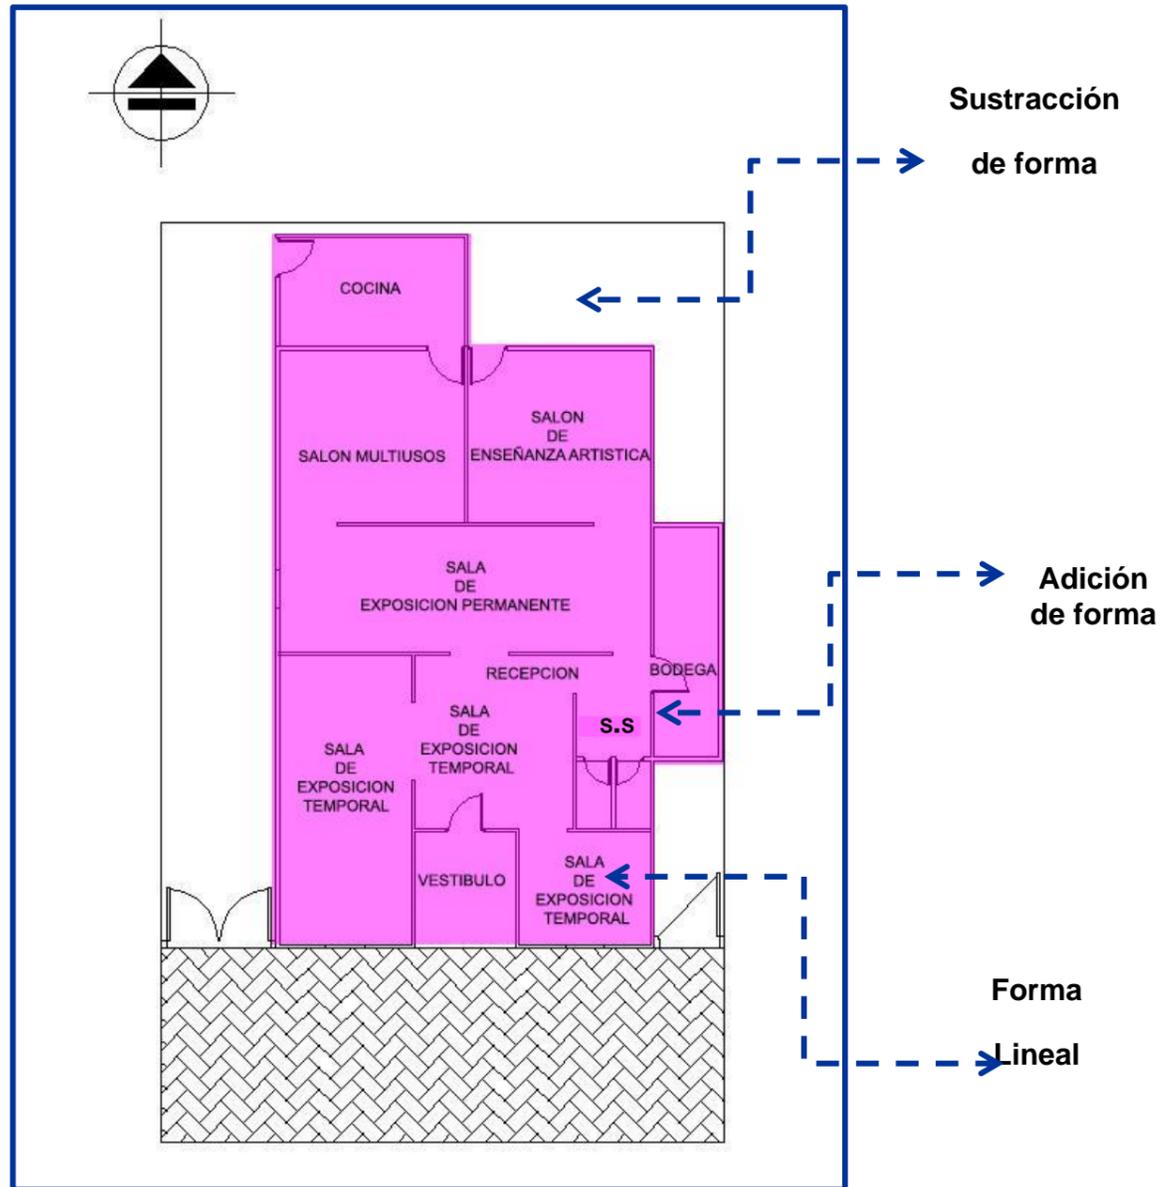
Planta arq. Galería Allegro. Fuente: Propia
